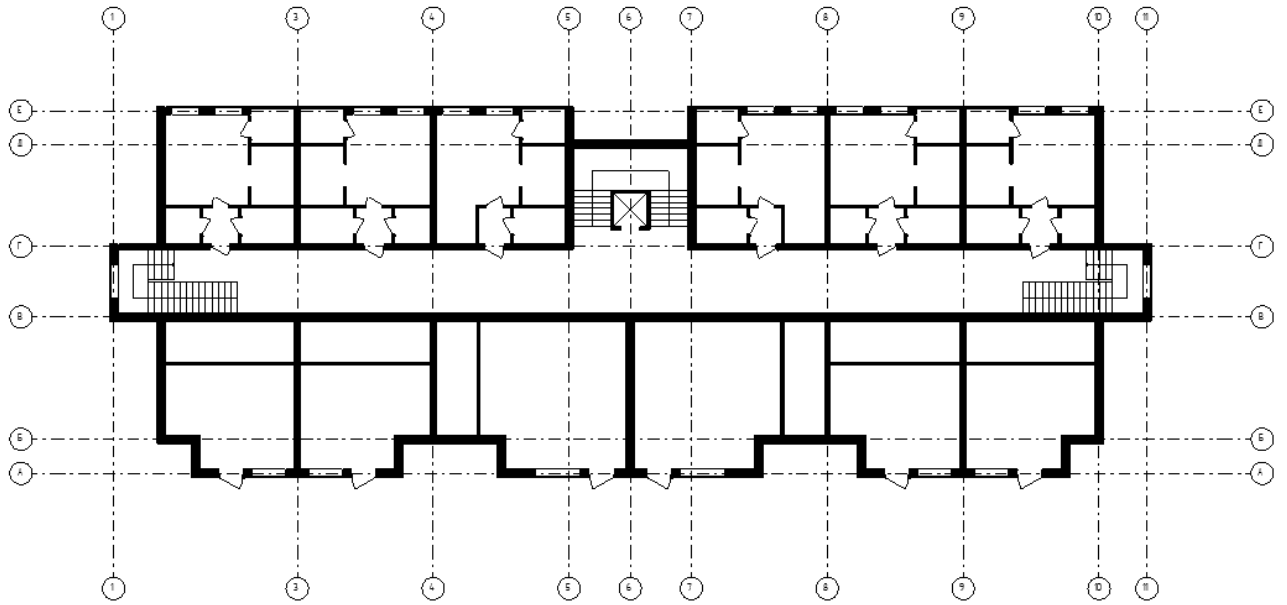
План 1 – го поверху будівлі 2 – го типу
